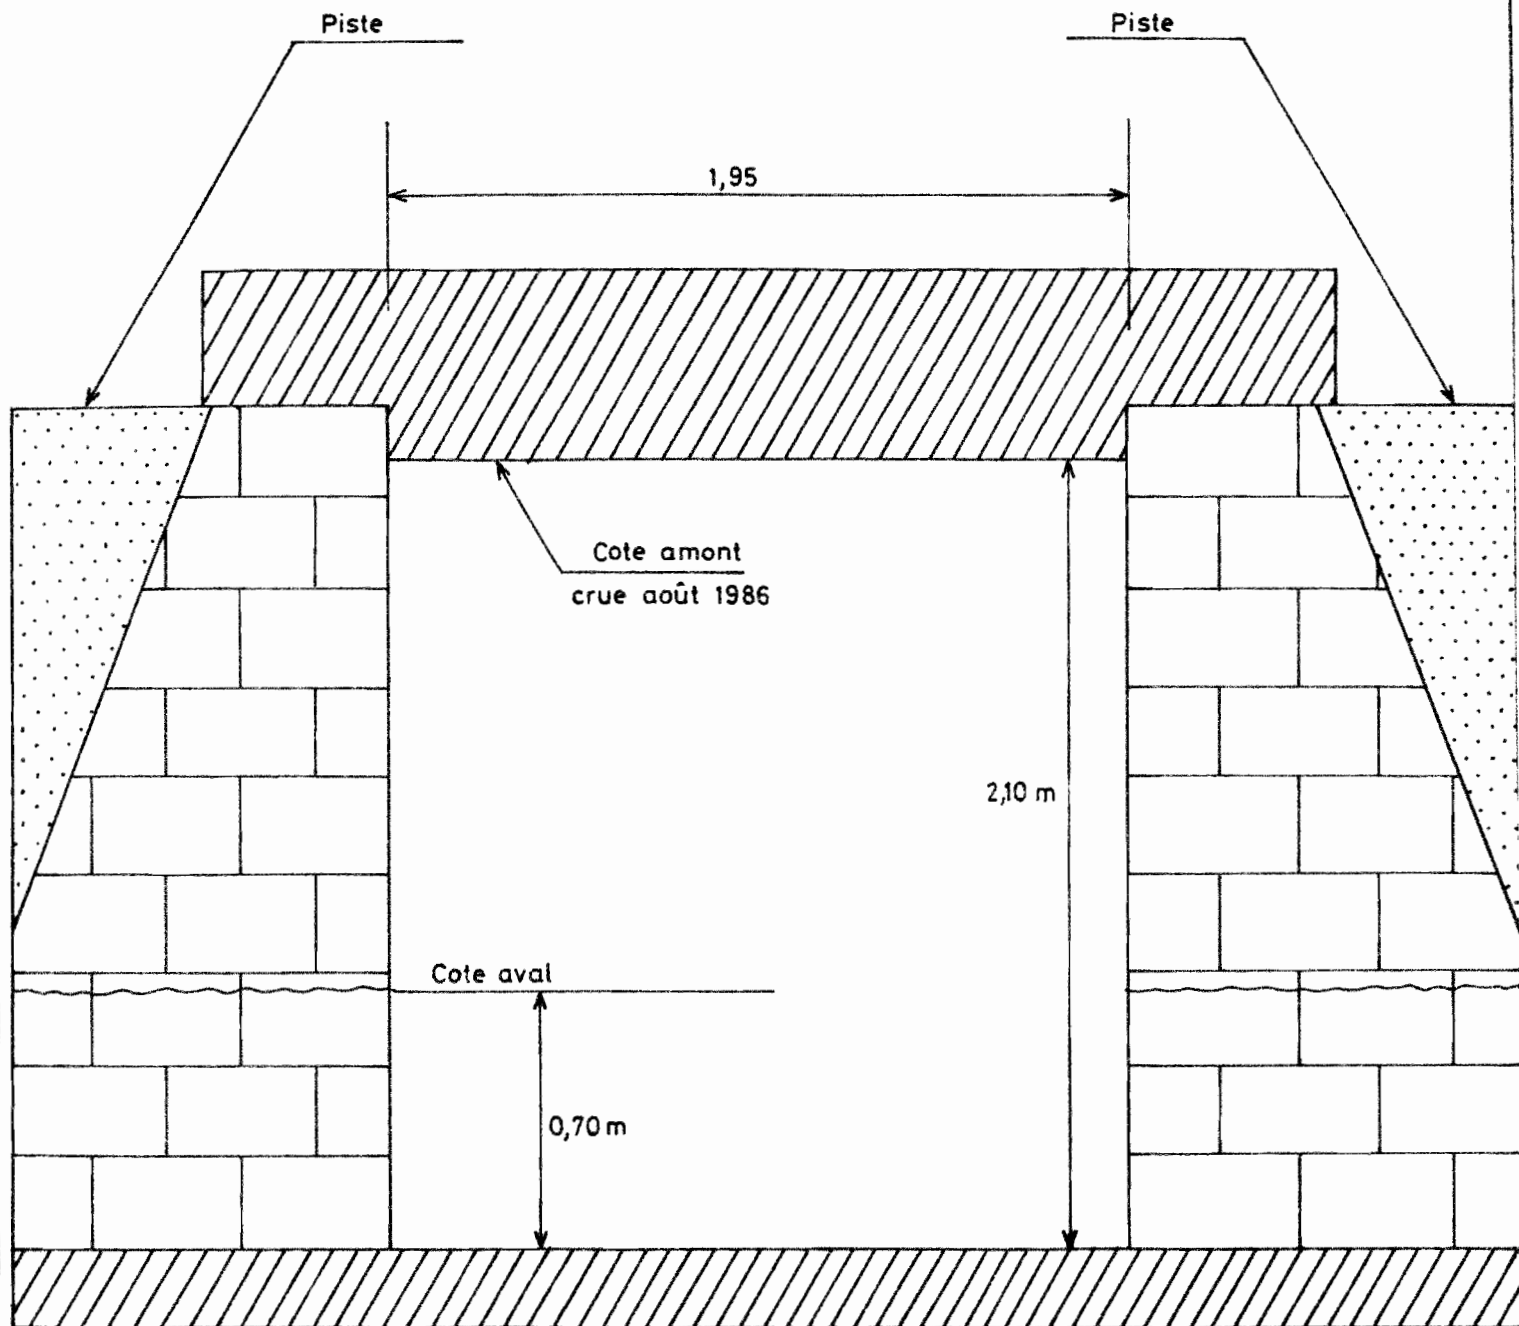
COUPE TRANSVERSALE DU PONT FRANCHISSANT
